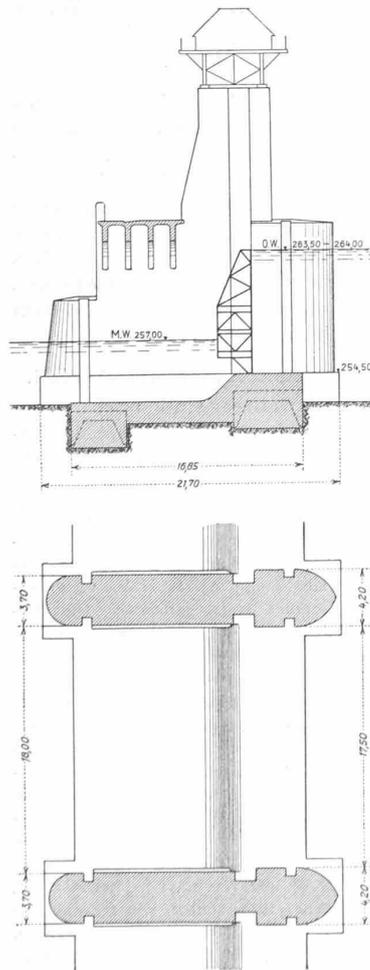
Querschnitt und Grundriss einer Wehrröffnung. — Masstab 1:500.
